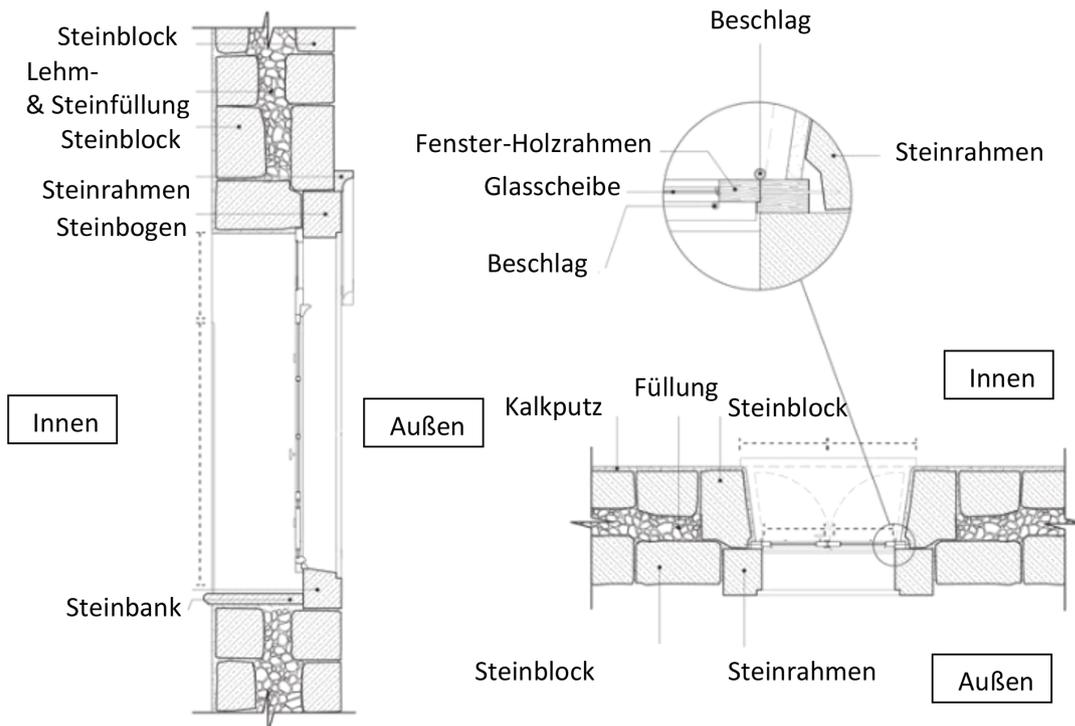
traditionelle Fenster-Ausführungsdetail- Schnitt & Grundriss
